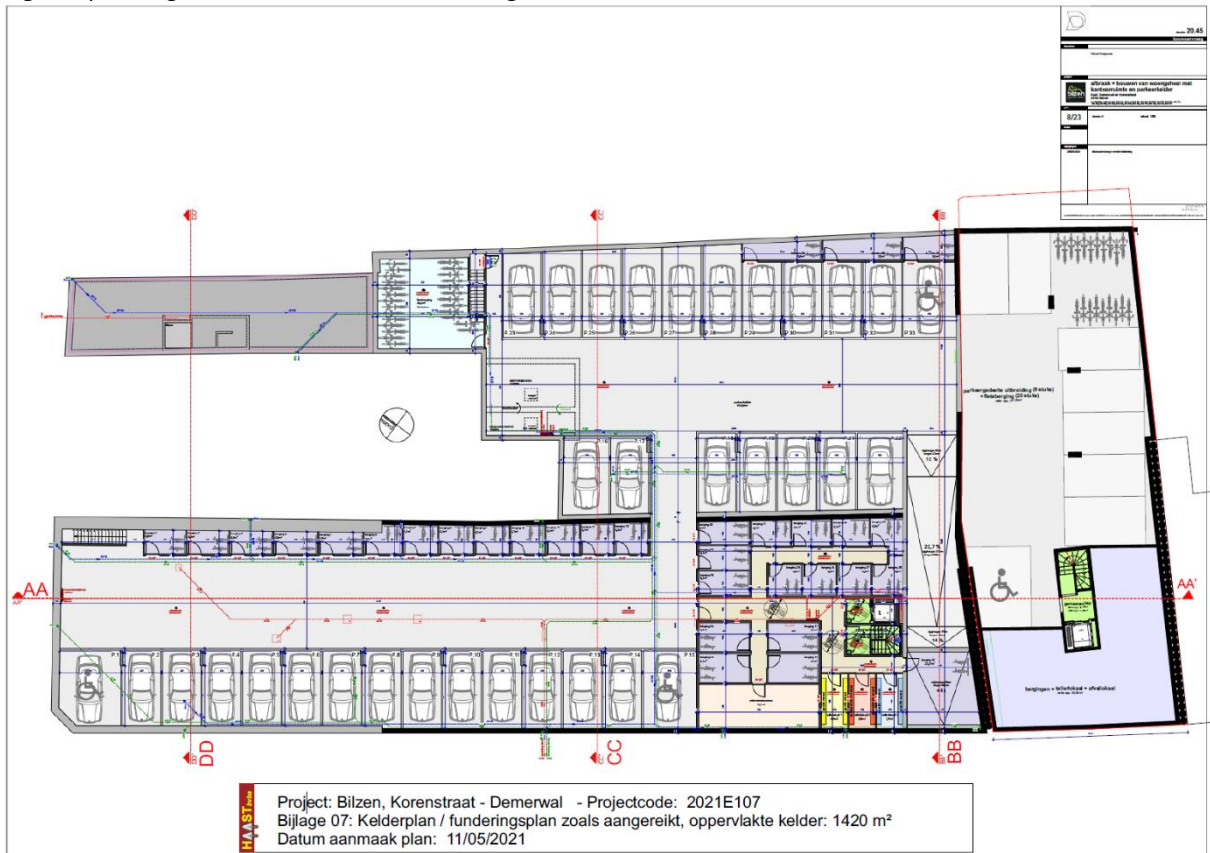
kelderplan / funderingsplan zoals aangereikt
